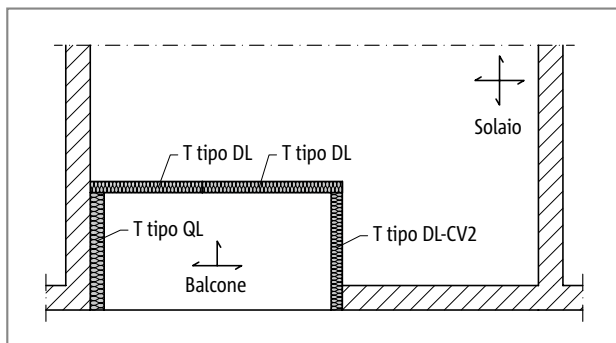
Schöck Isokorb® T tipo DL e tipo QL: solaio a orditura incrociata, l'effetto d'incastro di Schöck Isokorb® è comunque presente solo in modo monoassiale
